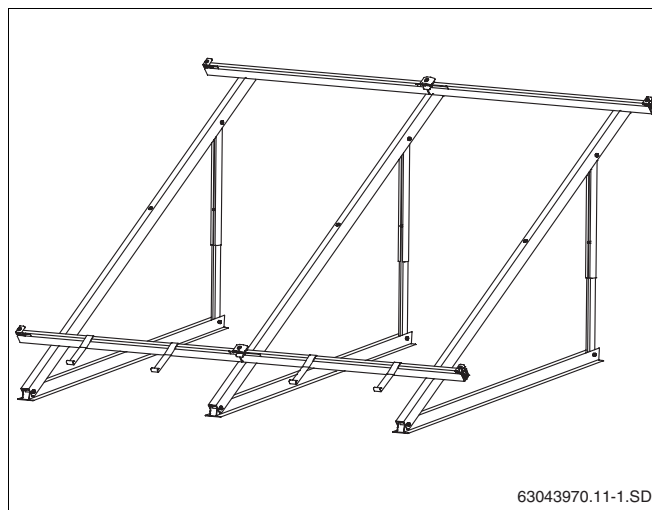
Suportes verticais para telhados planos para 2 colectores
